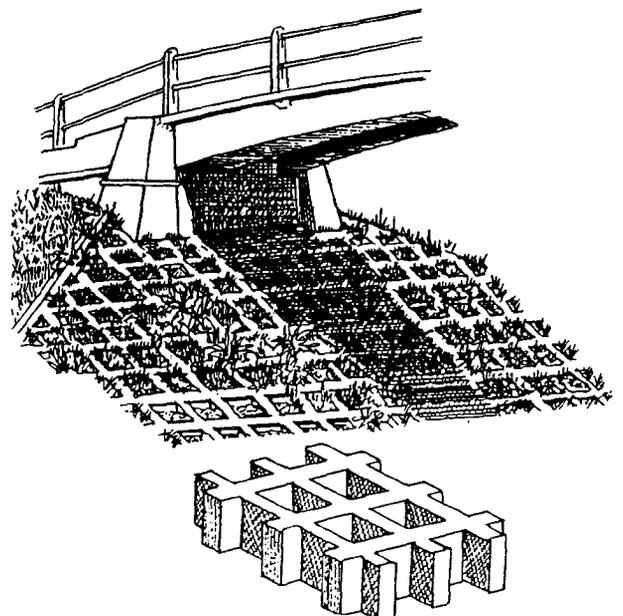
Talud protegido con bloques prefabricados de hormigón a modo de entramado.
